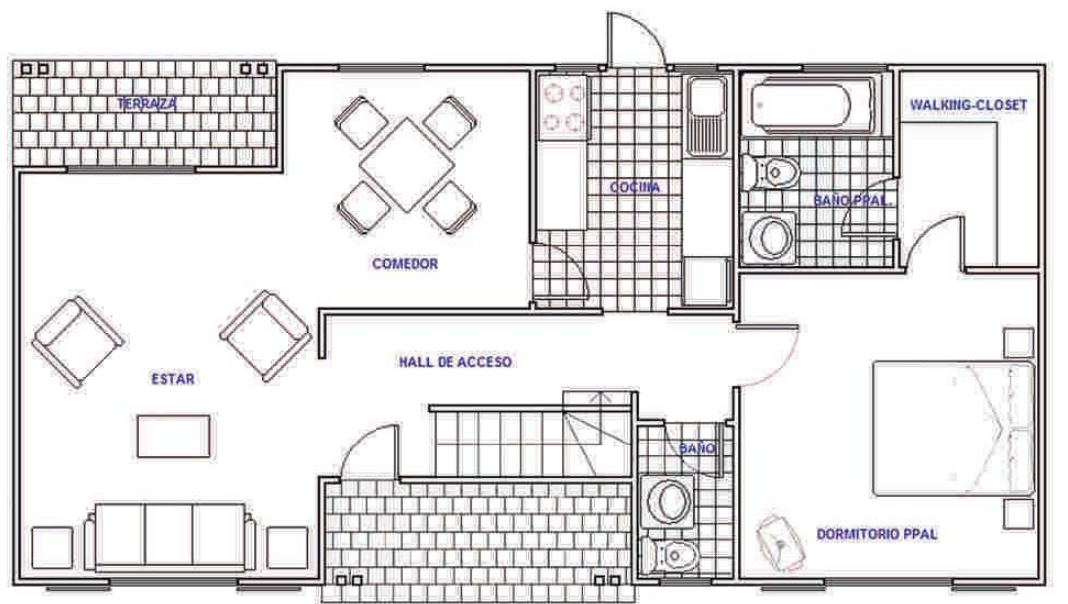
1: Plano planta de arquitectura del primer piso con distribución de recintos.
